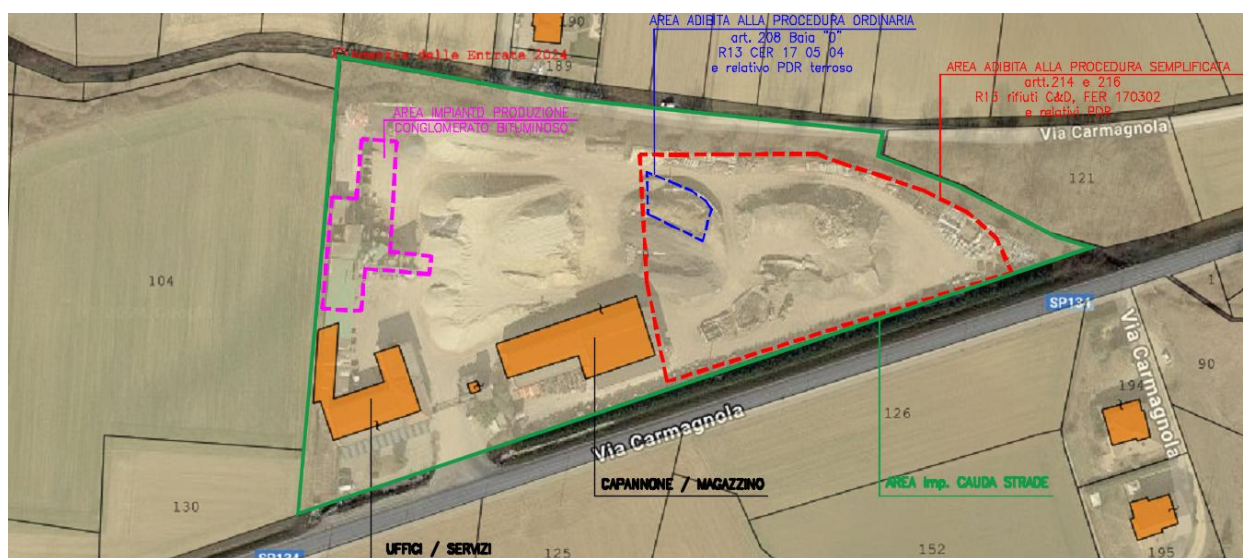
Planimetria generale insediamento CAUDA STRADE_ Pralormo (TO)
